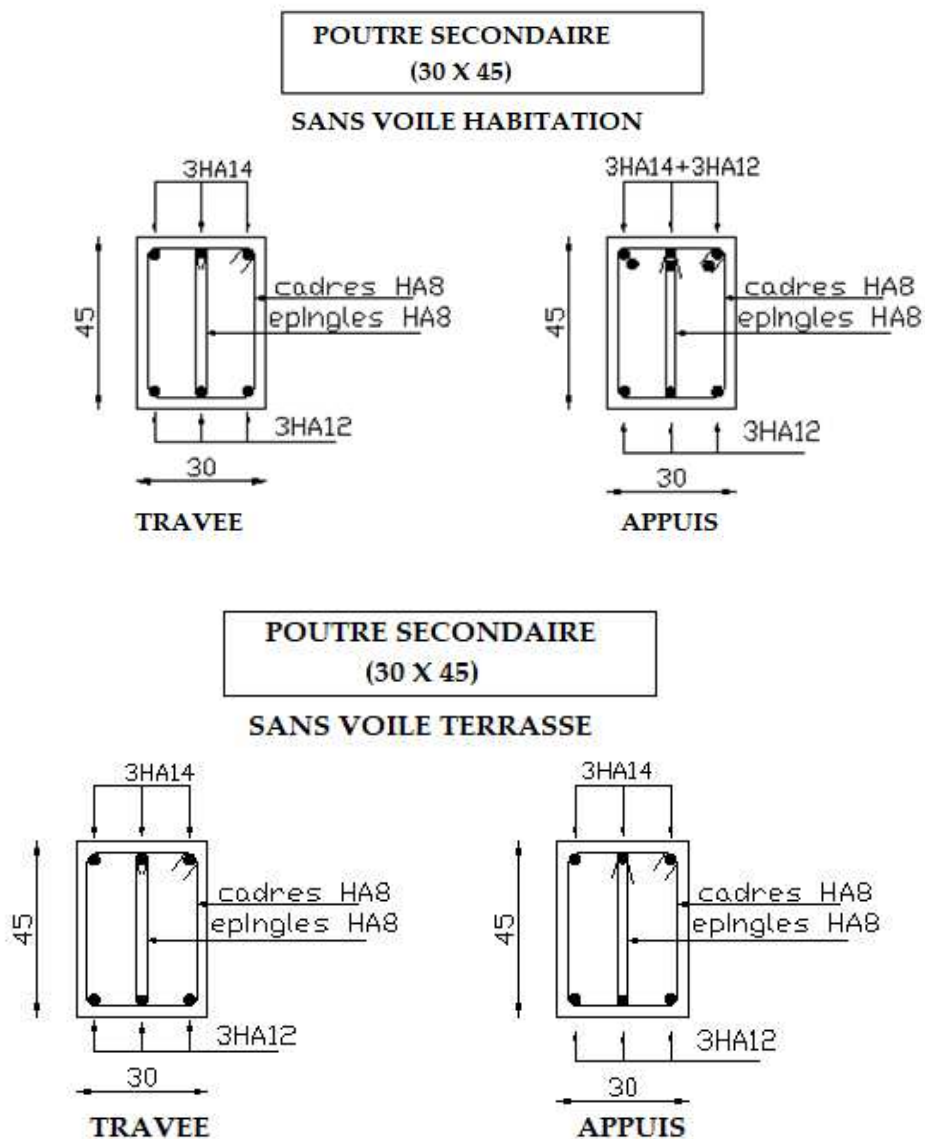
Ferrailage de poutre secondaire sans voile.
